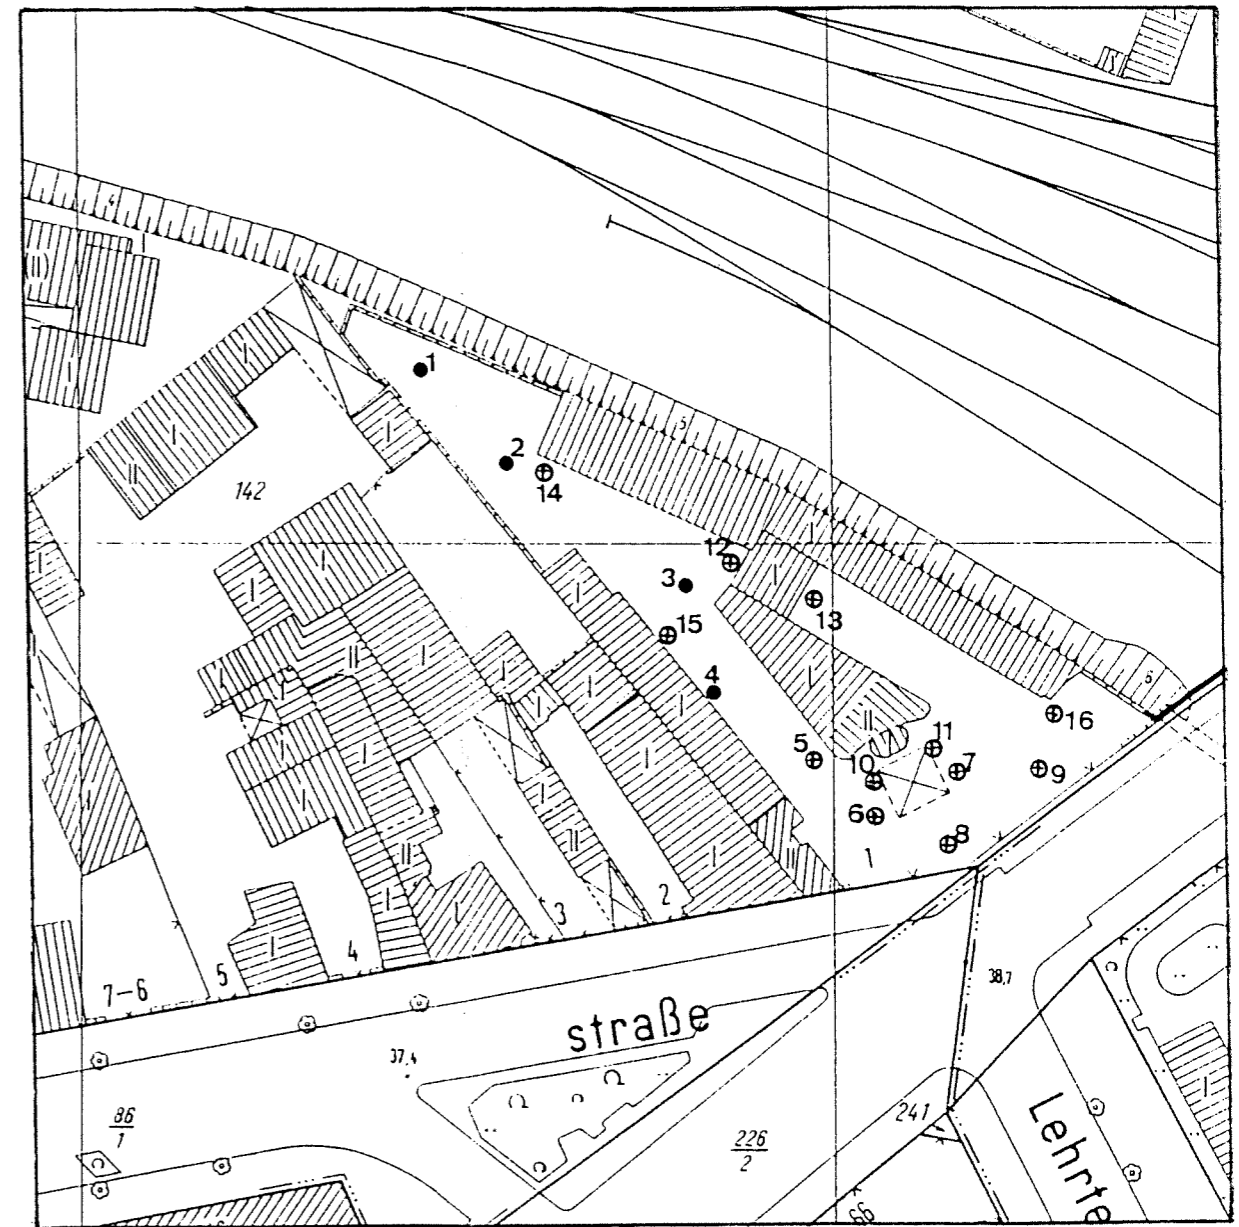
c : Verdachtsfläche 1 - Bohrpunktplan
